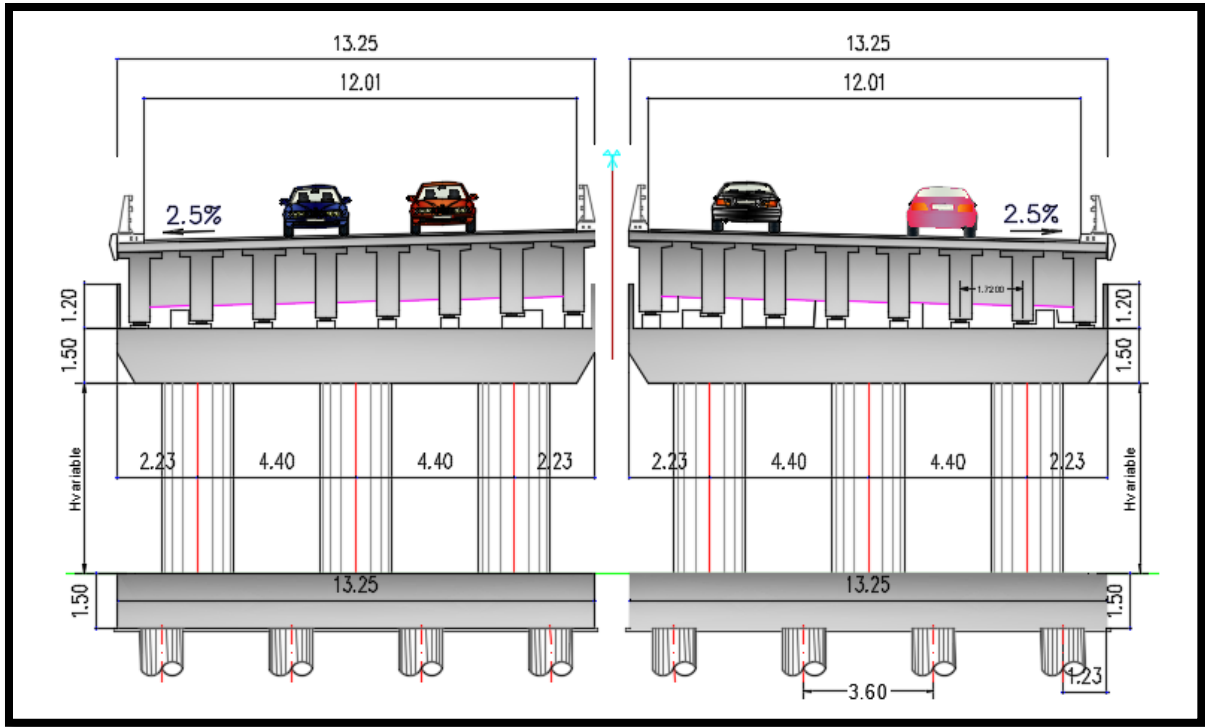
Coupe transversale sur pile VARIANTE 01
